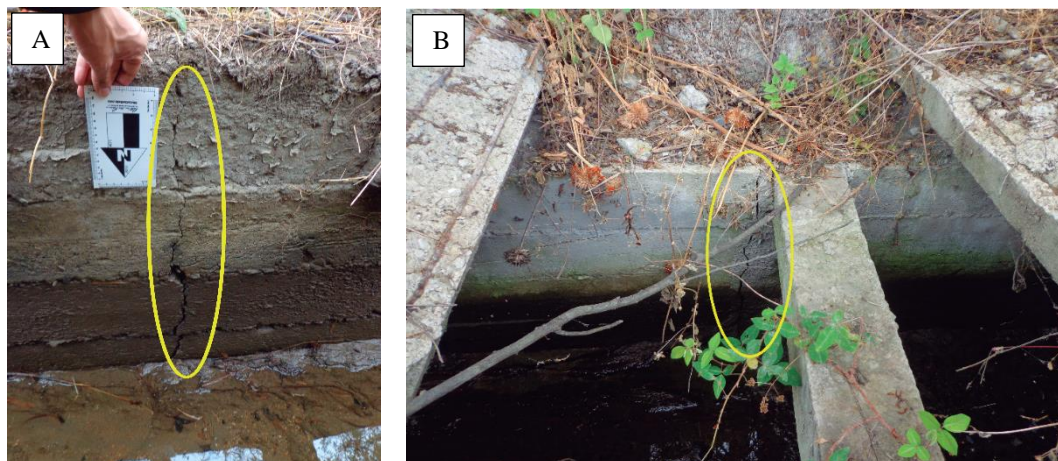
Tramo del canal que presenta daños CM₃ a) Grietas en la construcción del canal b) Reparación del canal con revestimiento plástico.
